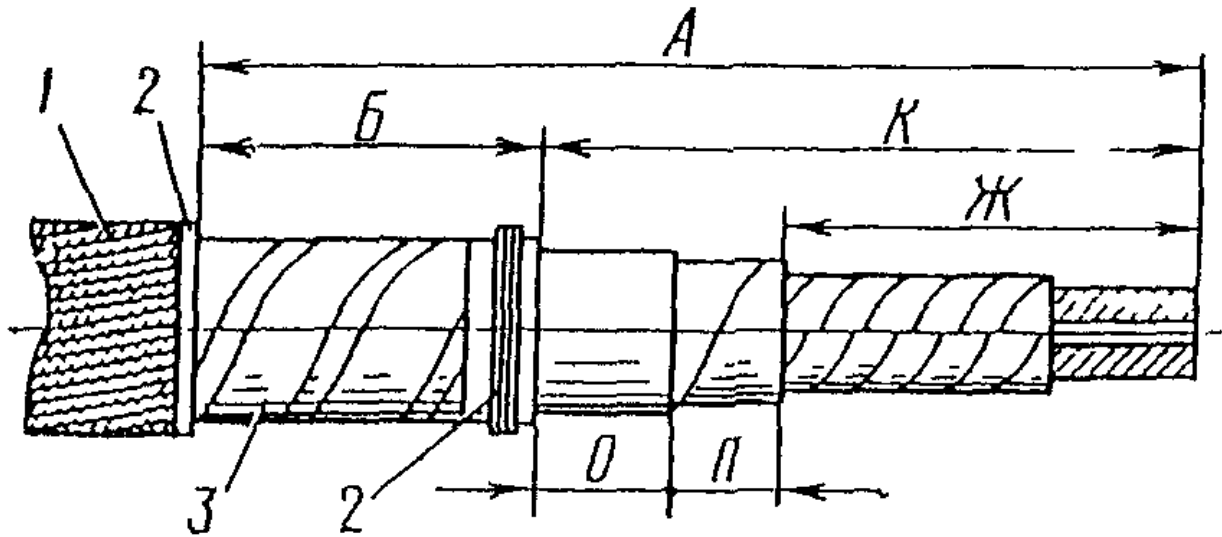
Разделка кабеля для монтажа соединительных муфт типов СЧ и СЧм: 1 - наружный покров; 2 - проволочный бандаж; 3 - броня
